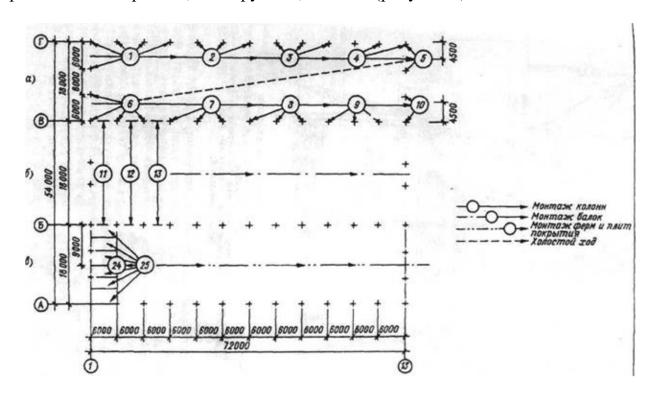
Параметры прохода крана при монтаже колонн, балок, ферм и плит покрытия
